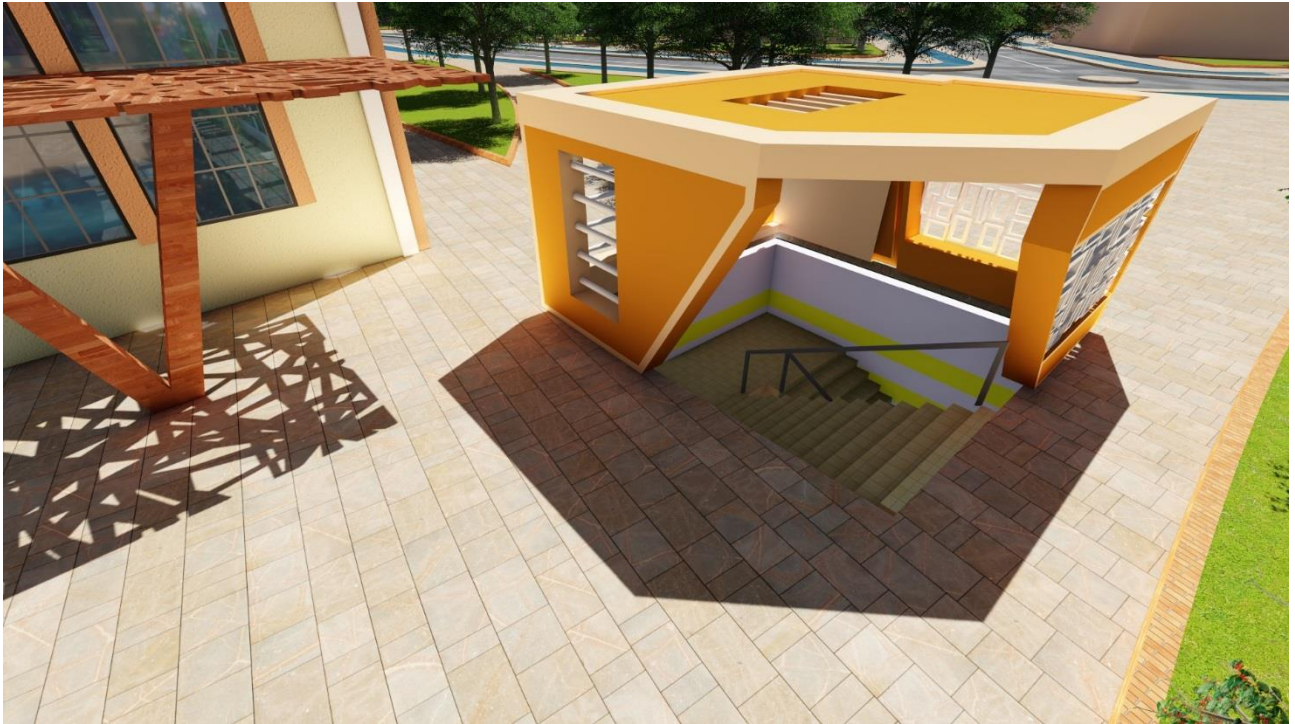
vue en 3D de cage d'escalier de parking sous-sol
